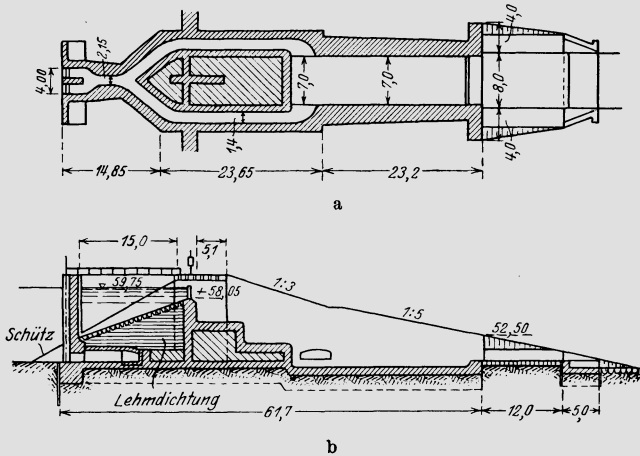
a u. b. Entlastungsanlage Roßnow. H.-W.-Überfall mit Grundablaß. Maßstab 1 : 1130.
